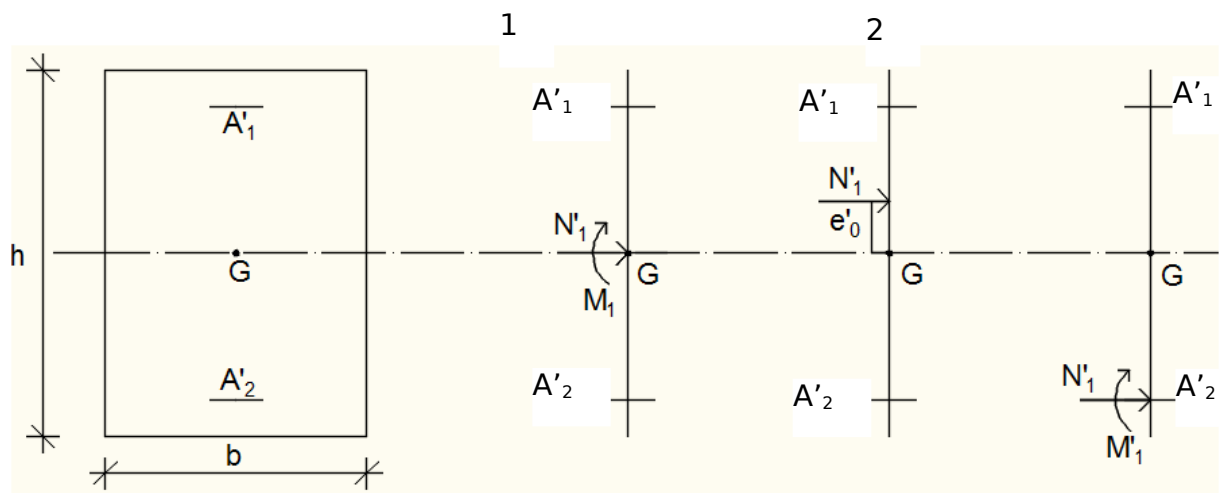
Position de N'_1 , M'_1 et M_1 sur la section transversale.
